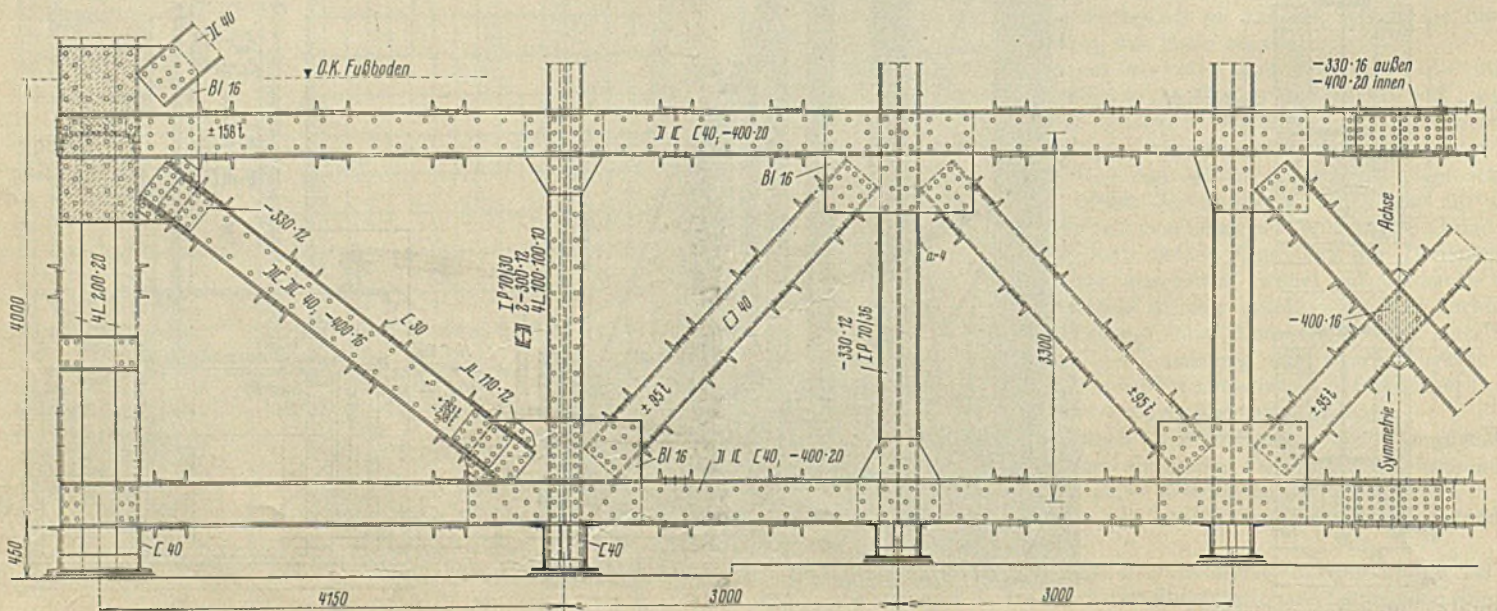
Fundamentriegel der Frontwandrahmen der Ehrenhalle.
